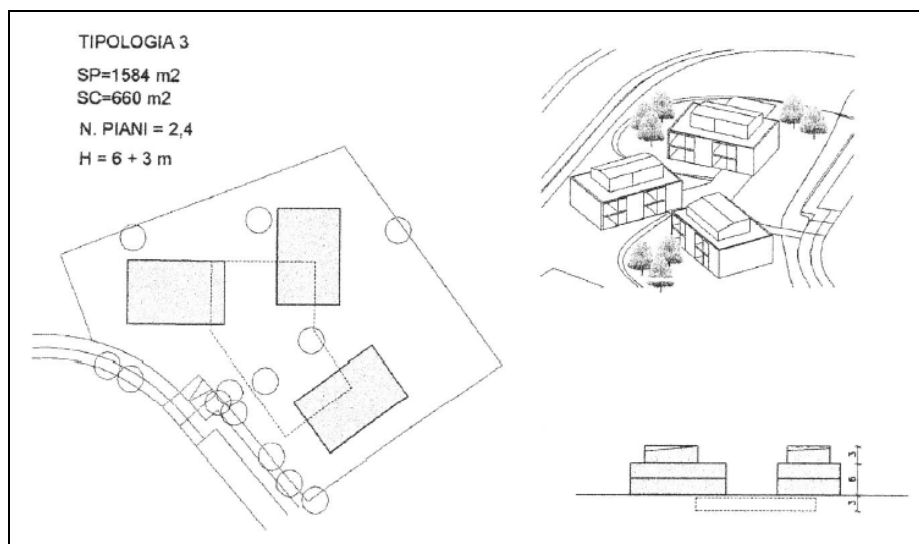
Estratto dalla Relazione tecnica del P.d.L. (Allegato 3)
